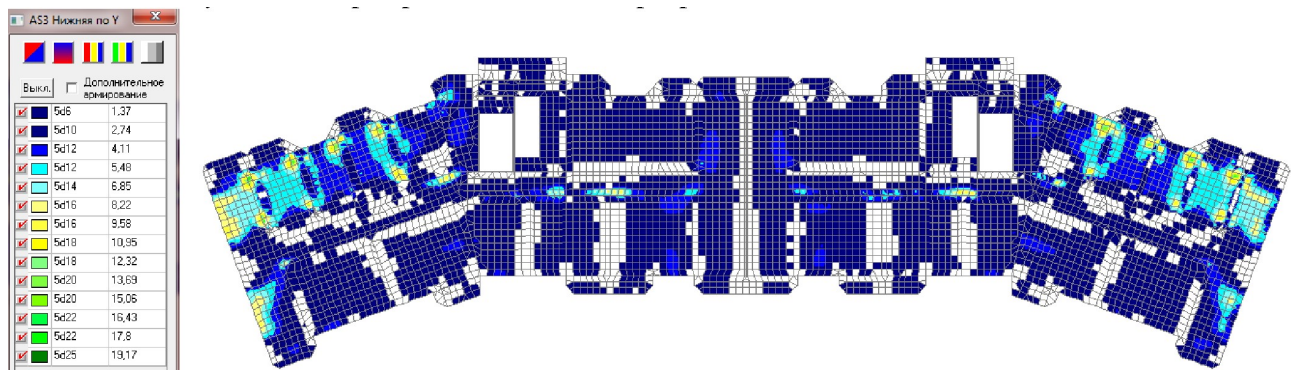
Армування плити перекриття типового поверху нижнє за Y
